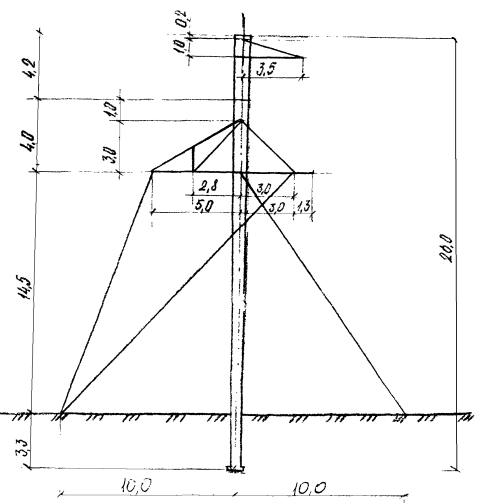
Одноопорные железобетонные опоры ВЛ 220 кВ
